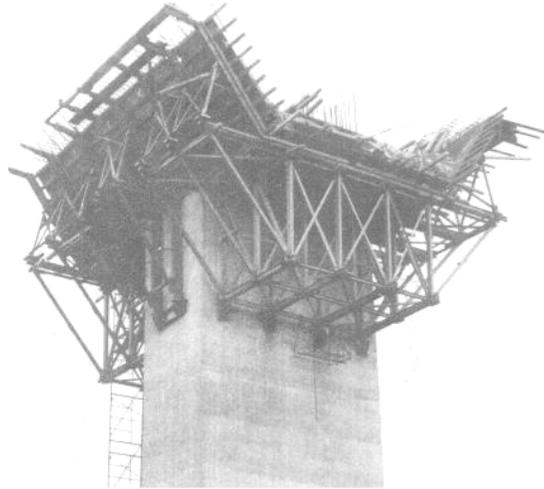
Dovela de pila, Puente Antonio Dovalí
